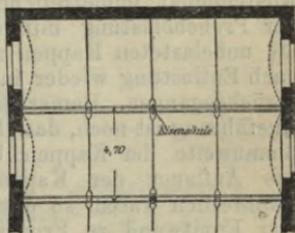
Grundriss der Moniergewölbe im Hausvoigt.
